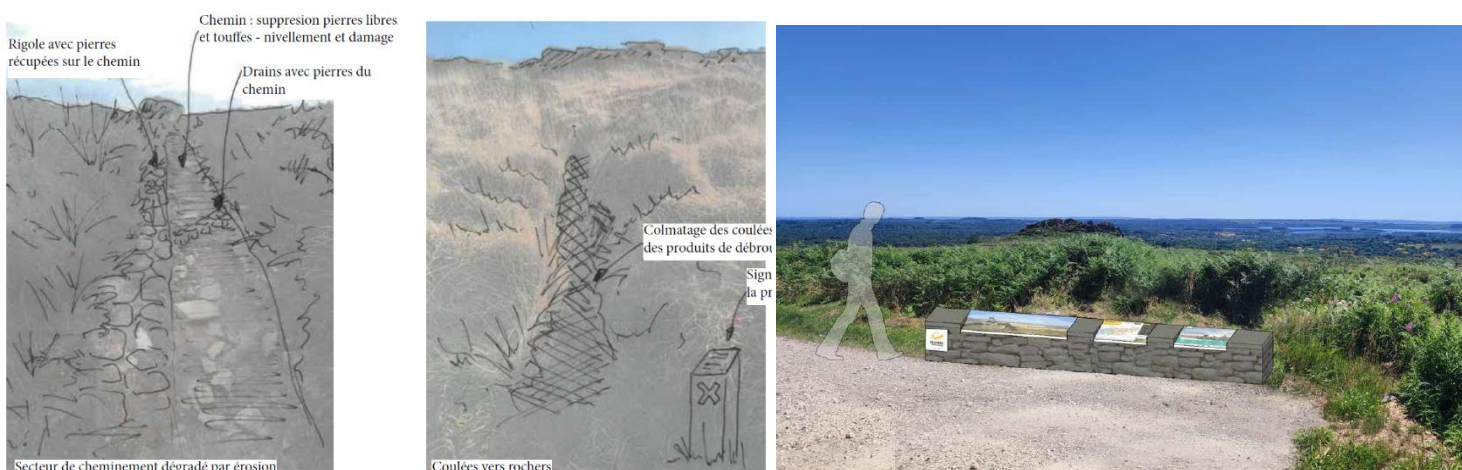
Exemple de travaux de restauration de sentiers et de panneau de sensibilisation
